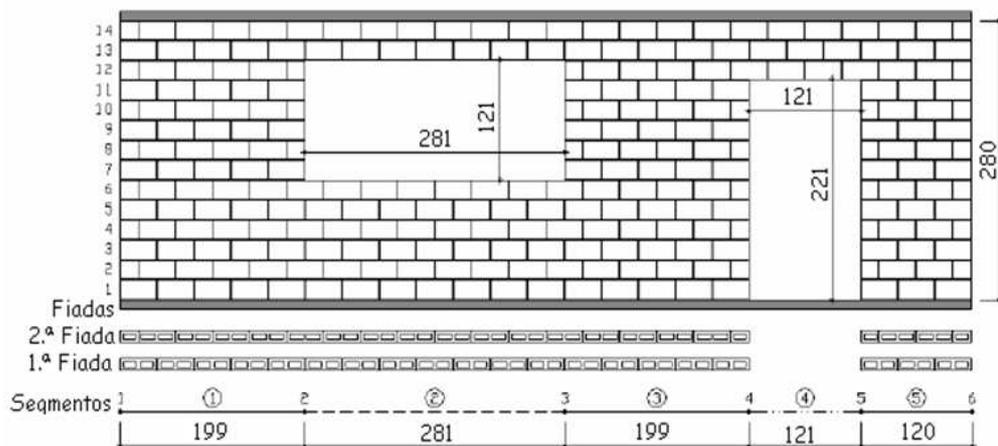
Elevação de Parede com detalhes da 1.ª e 2.ª fiadas
